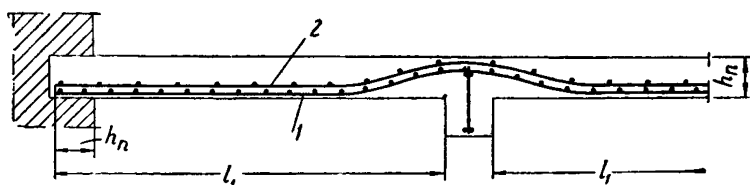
Армирование сварными рулонными сетками крайних панелей плит, опертых по контуру
